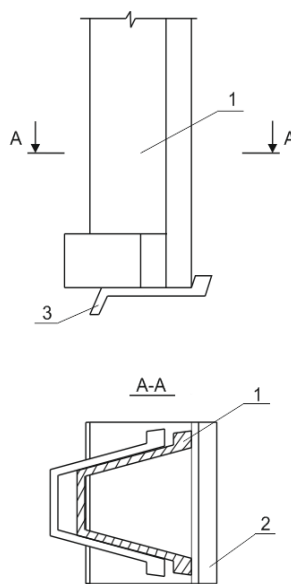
Схема монтажа стойки рамы на опорной плите ОПК-3
